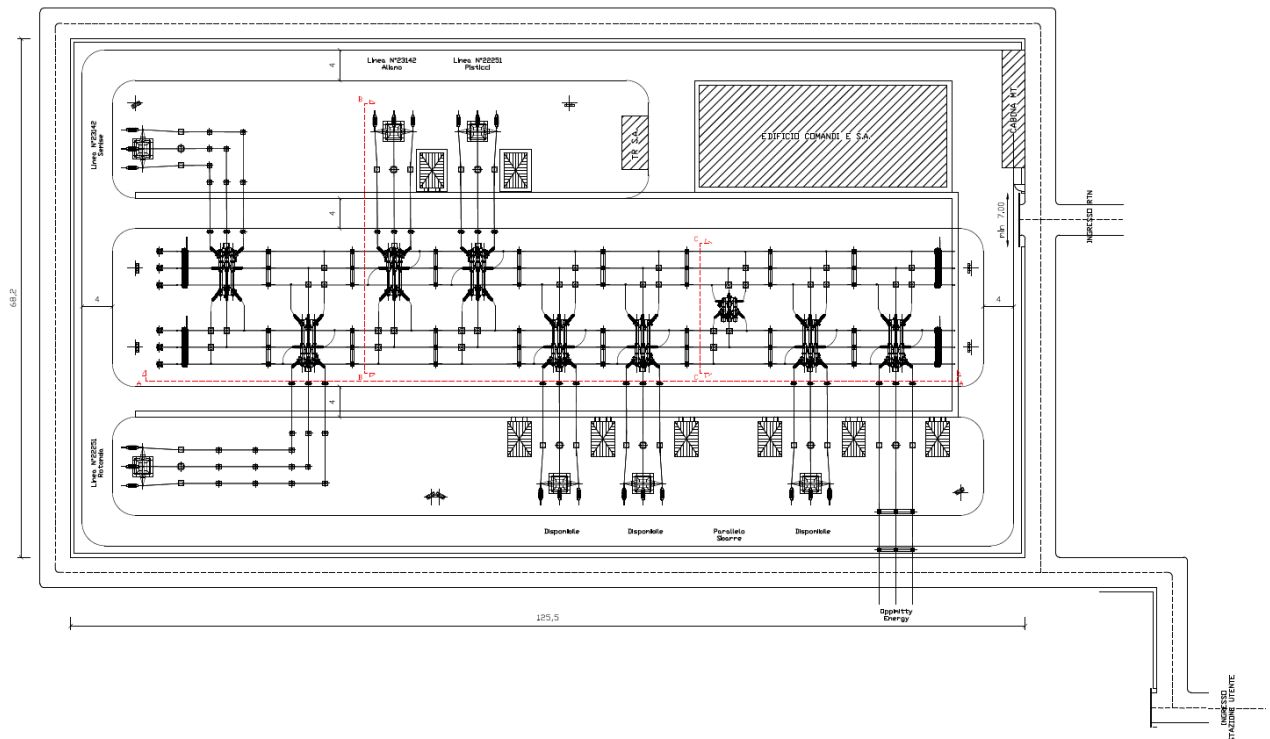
Planimetria nuova stazione elettrica di Sant'Arcangelo con ubicazione dell'assegnazione degli stalli
